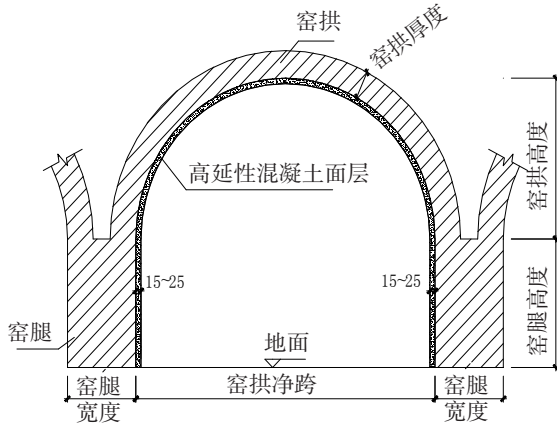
高延性混凝土面层加固窑洞剖面示意图
